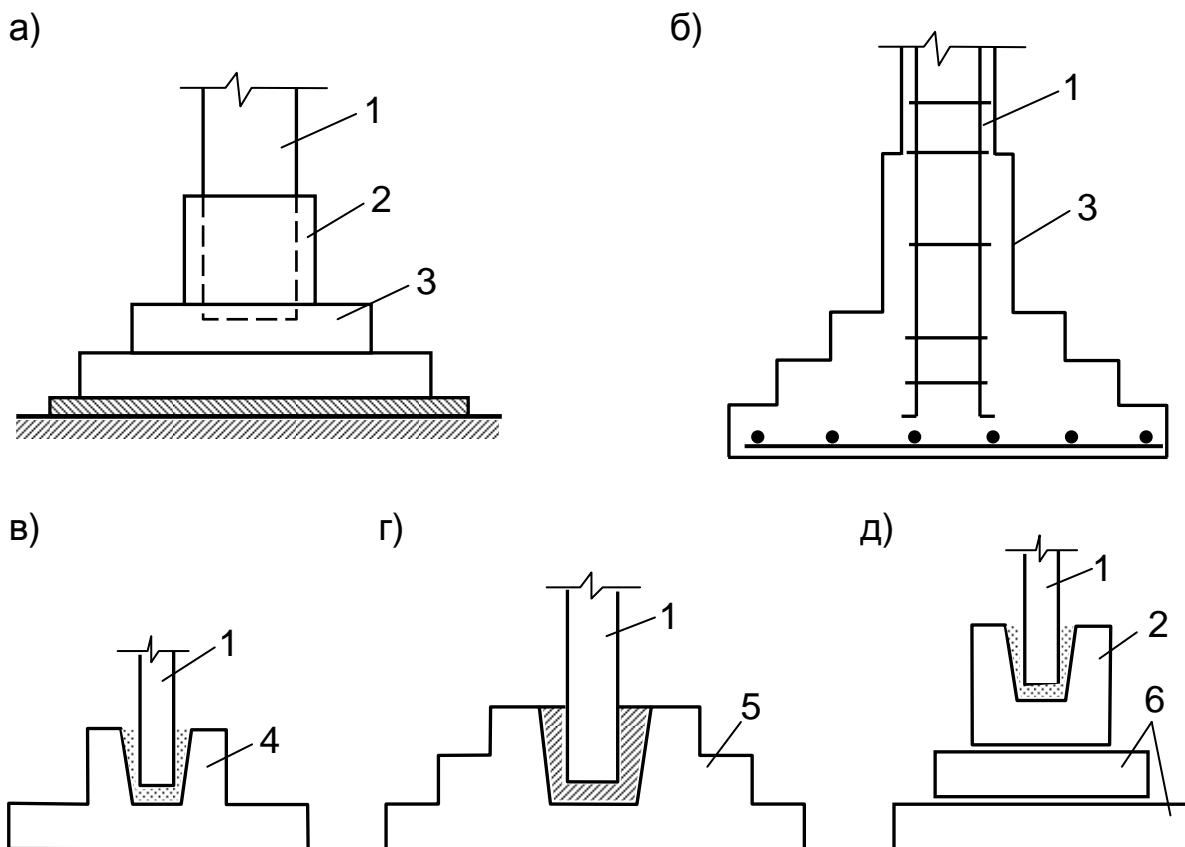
Монолитные (а, б) и сборные (в, г, д) железобетонные фундаменты:
